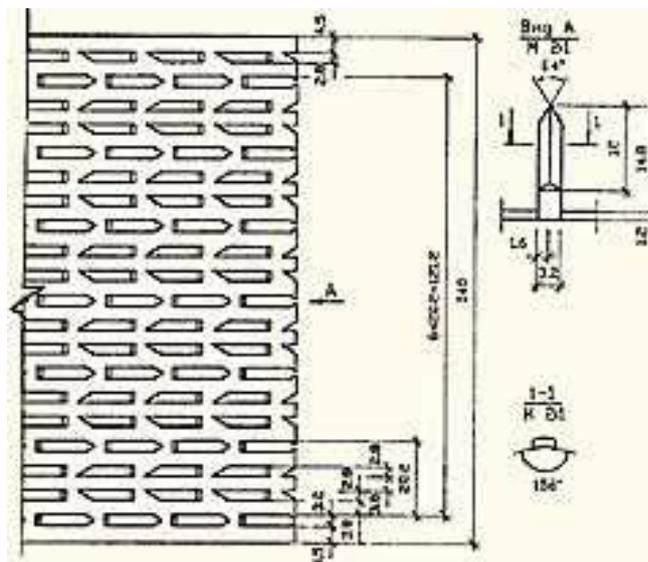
Металлическая зубчатая пластина типа Арпад.
